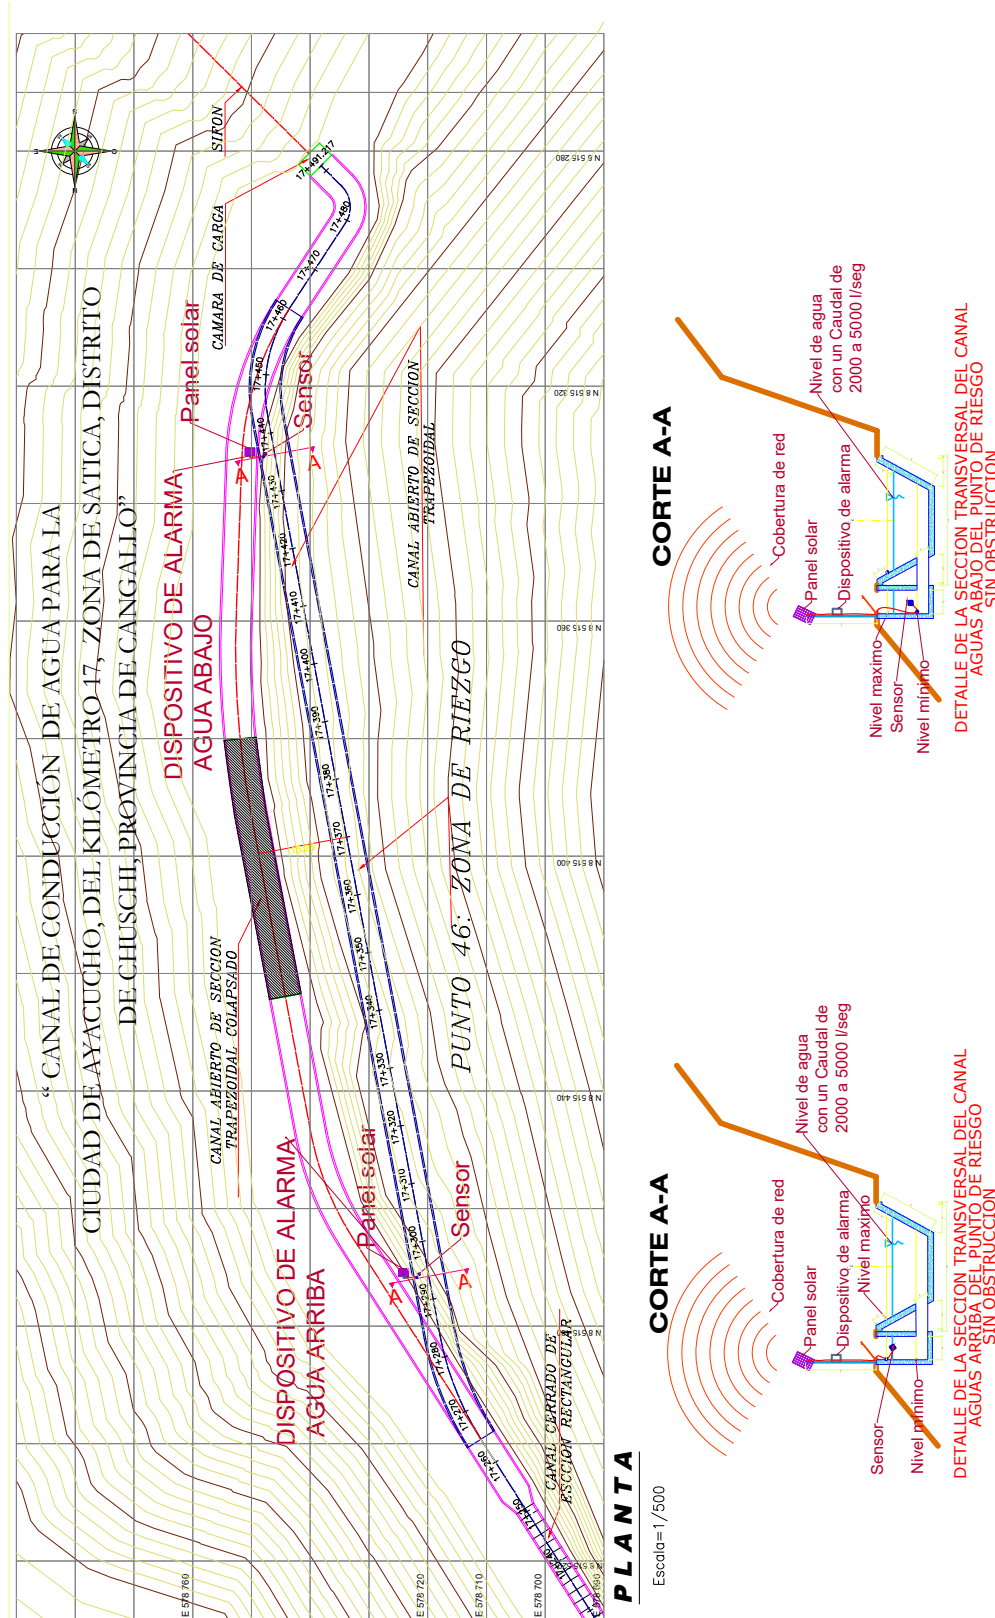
Esquema de la vista en planta y la sección transversal del canal con el sistema de alarma
